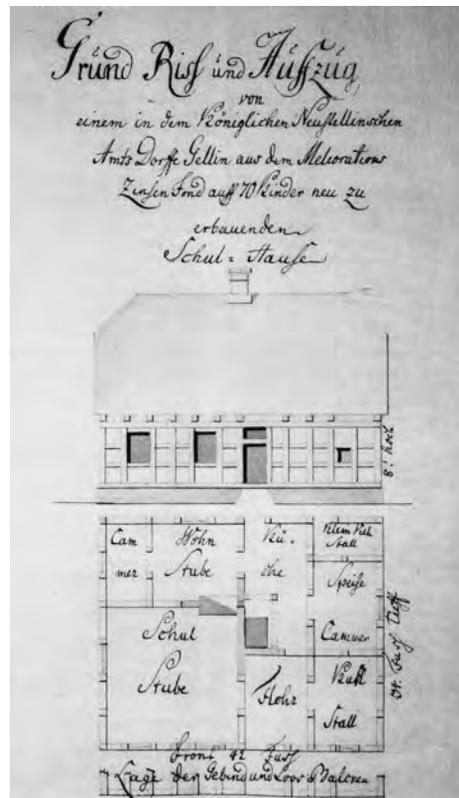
Grundriß von einem im königlichen Amtdorf Gellin zu erbauenden Schulhaus vom 26.02.1780
